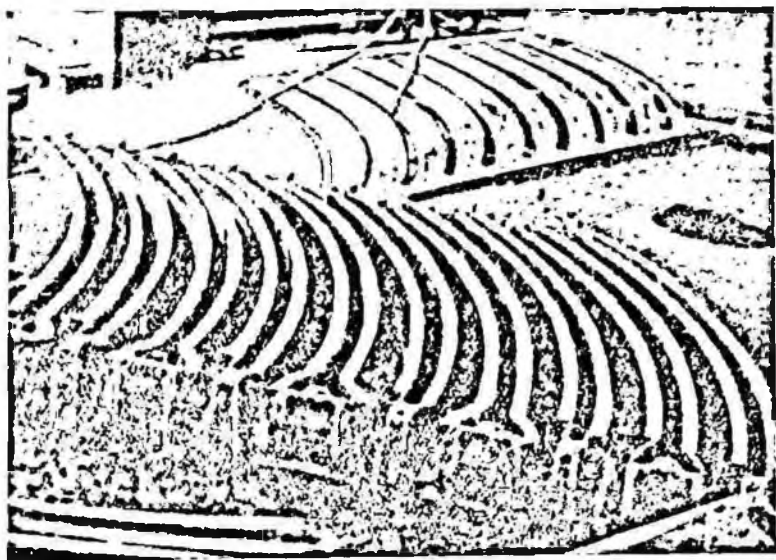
Металлическая опалубка на полигоне железобетонных изделий
